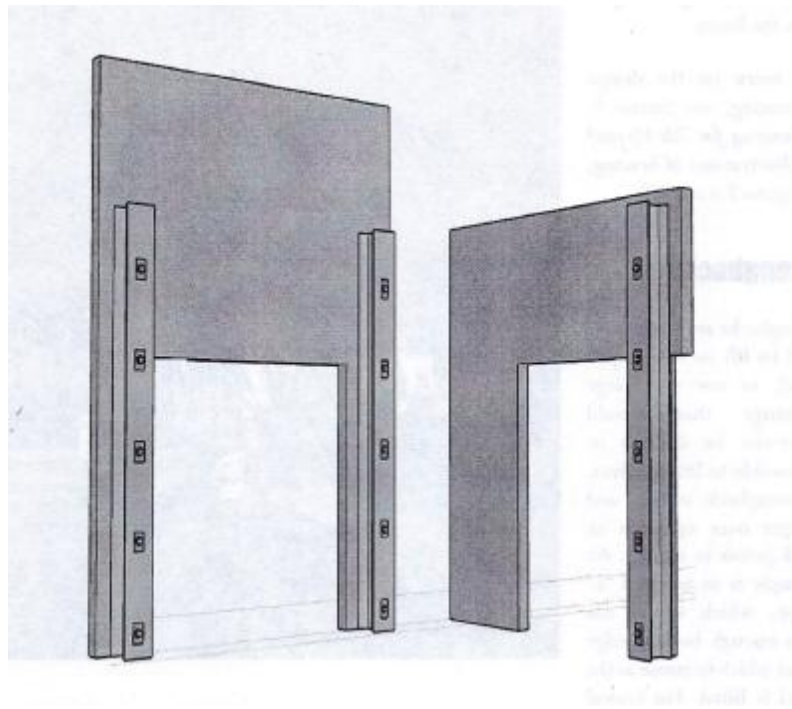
Sistema estrutural de travamento do Tilt-up
